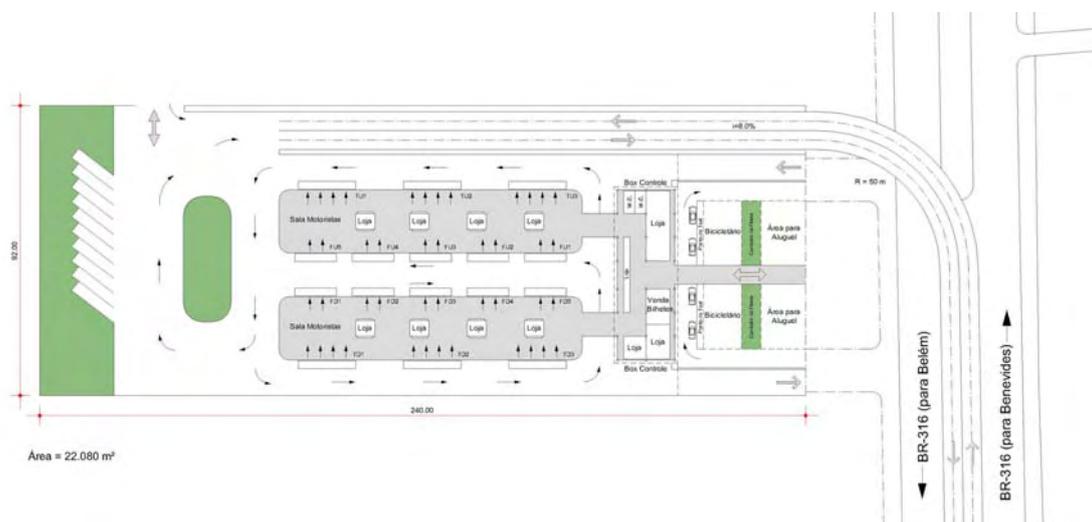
Proposta de planta baixa do Terminal Marituba
